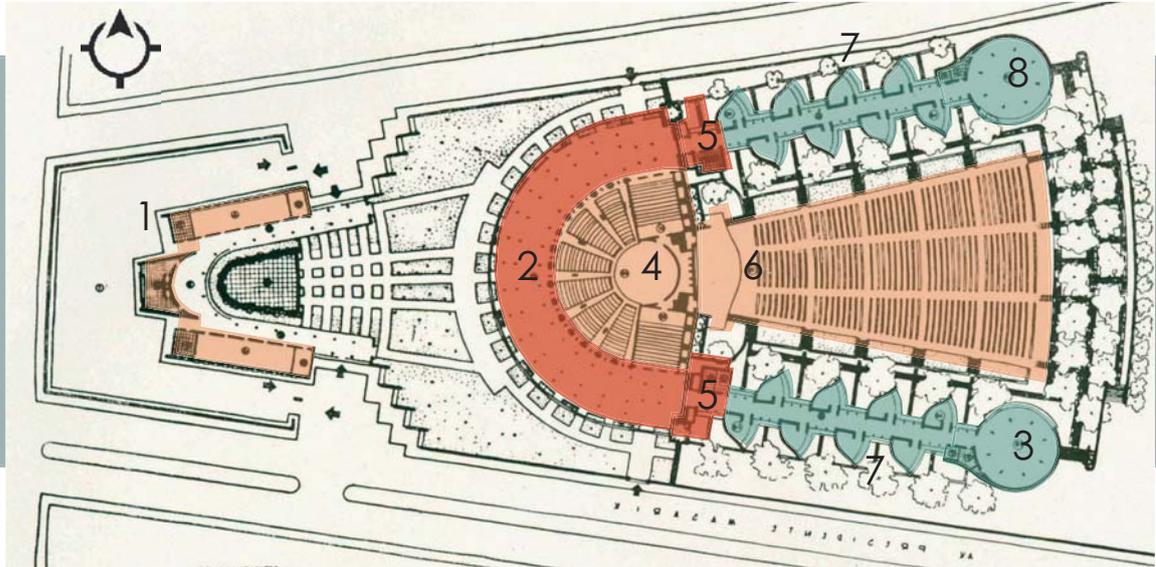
PLANTA ARQUITECTÓNICA, PLANTA BAJA.
